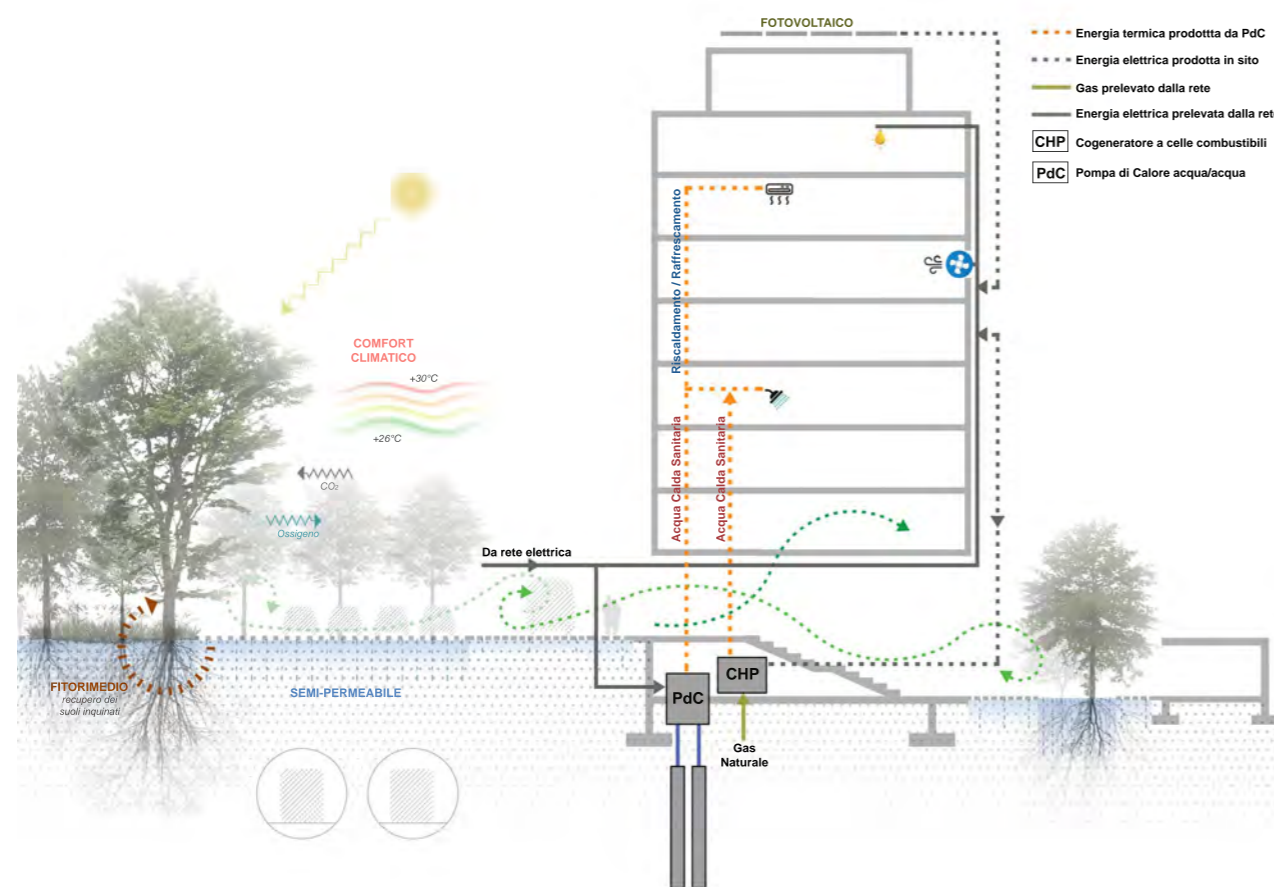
Sezione edificio con indicazione schematica impianti.
